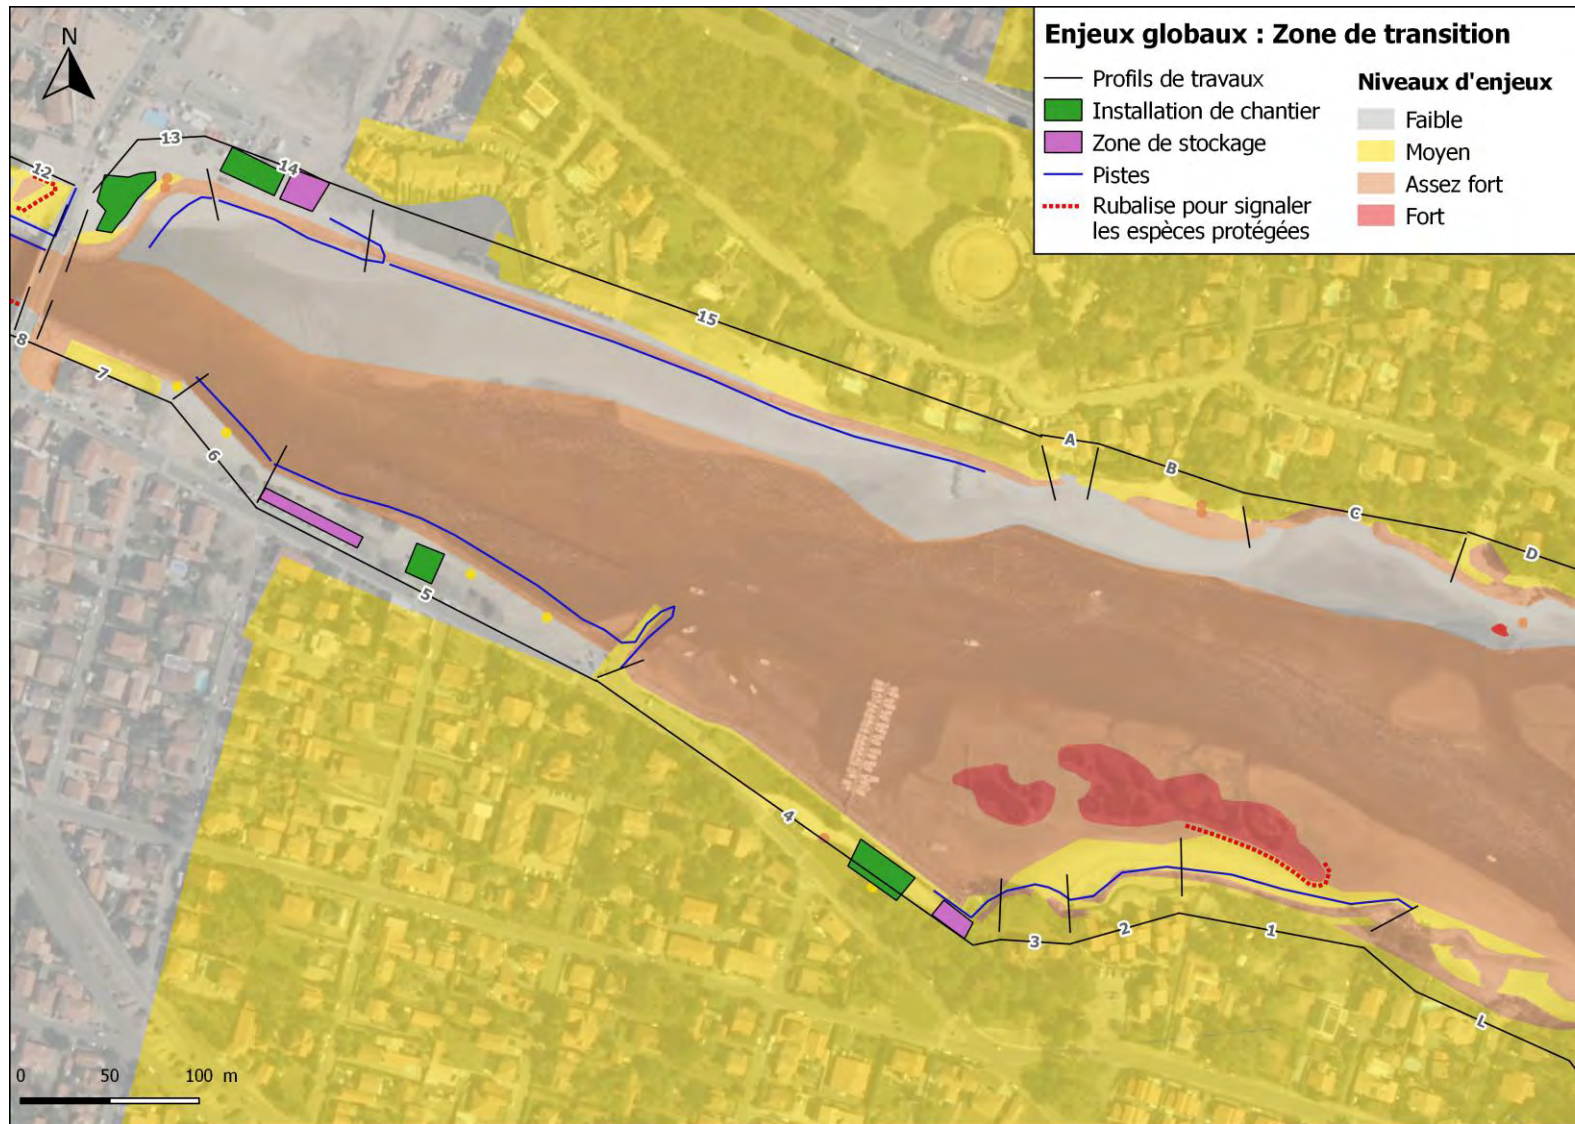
Dispositions constructives et enjeux environnementaux en espace de transition
